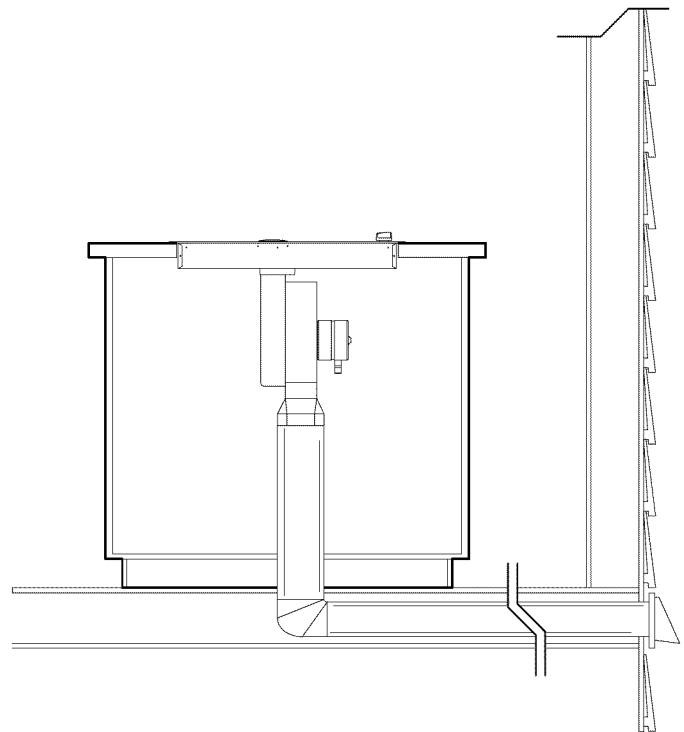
CONDUIT À TRAVERS LE PLANCHER
